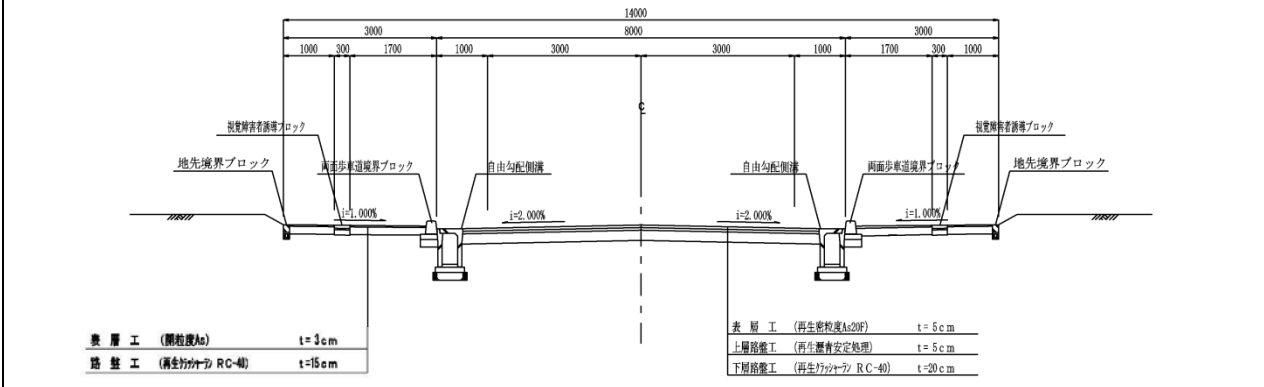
(2) 道路断面図(補助幹線道路:14m 標準断面)
